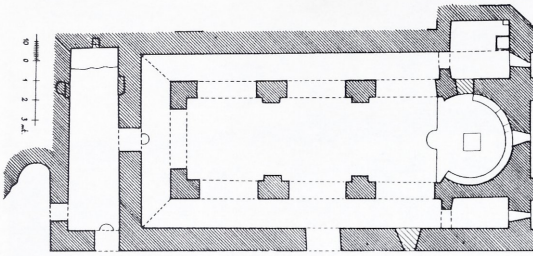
Gurdtschani, Kirche Kwela Zminda, Grundriss der Unterkirche
